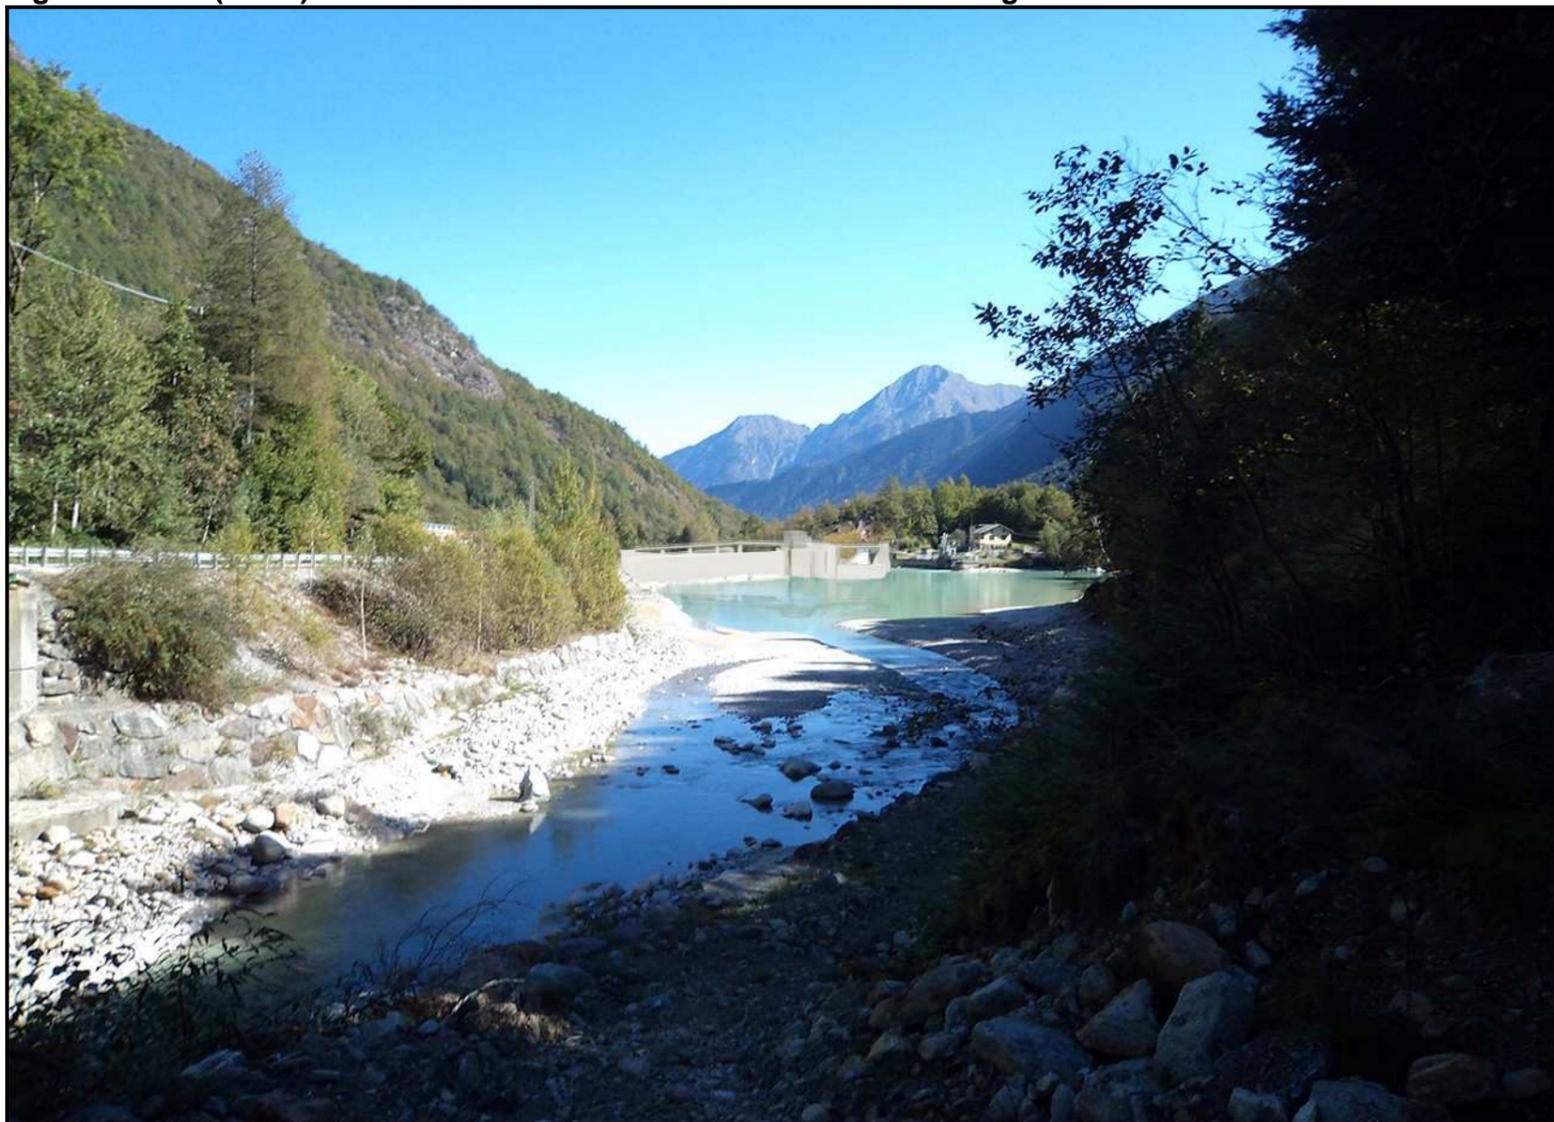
I (1 di 2) Vista a volo d'uccello – Stato Attuale
